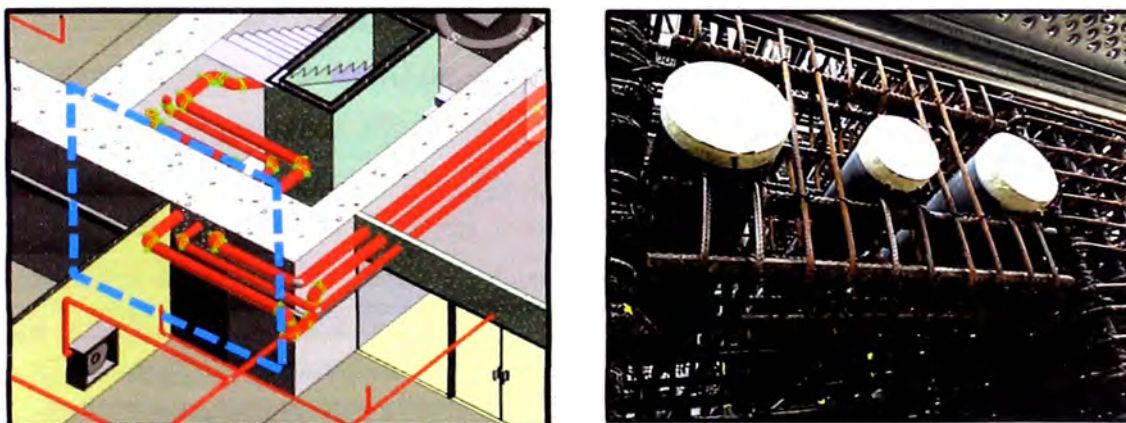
37: Ubicación de Pases estructurales en vigas de concreto usando el modelo BIM
